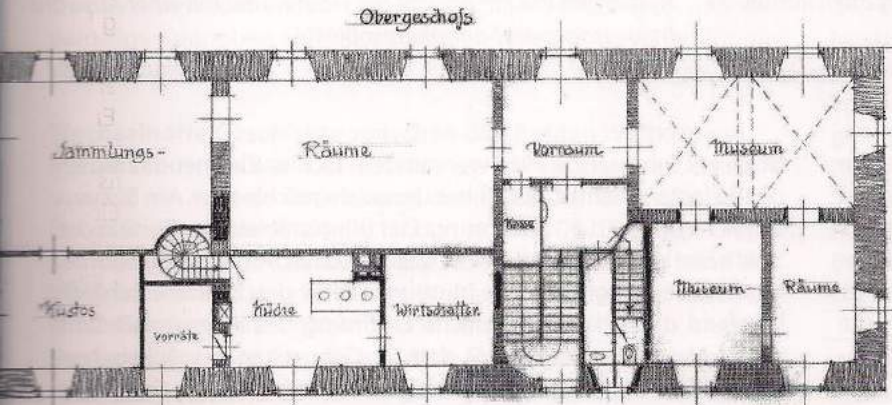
Grundrissplan des 1. Obergeschosses im alten Rathaus mit der Nutzungsvariante Museum.
